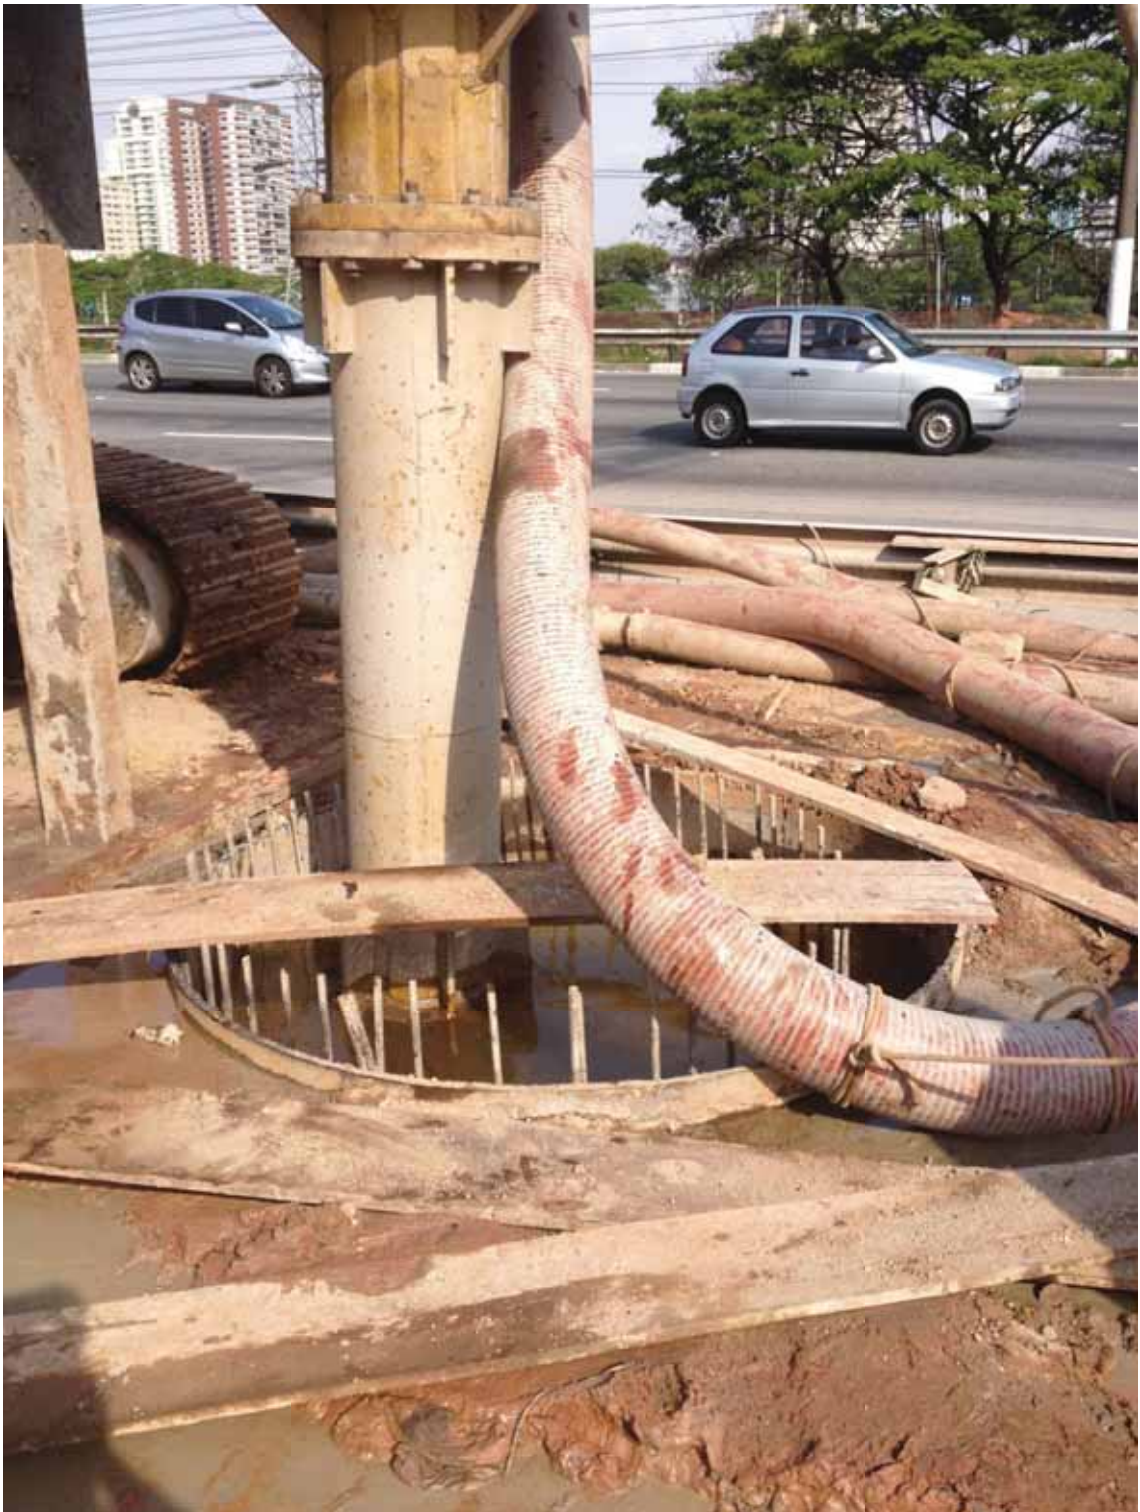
Concretagem dos estações do AP5 [11/2014]
